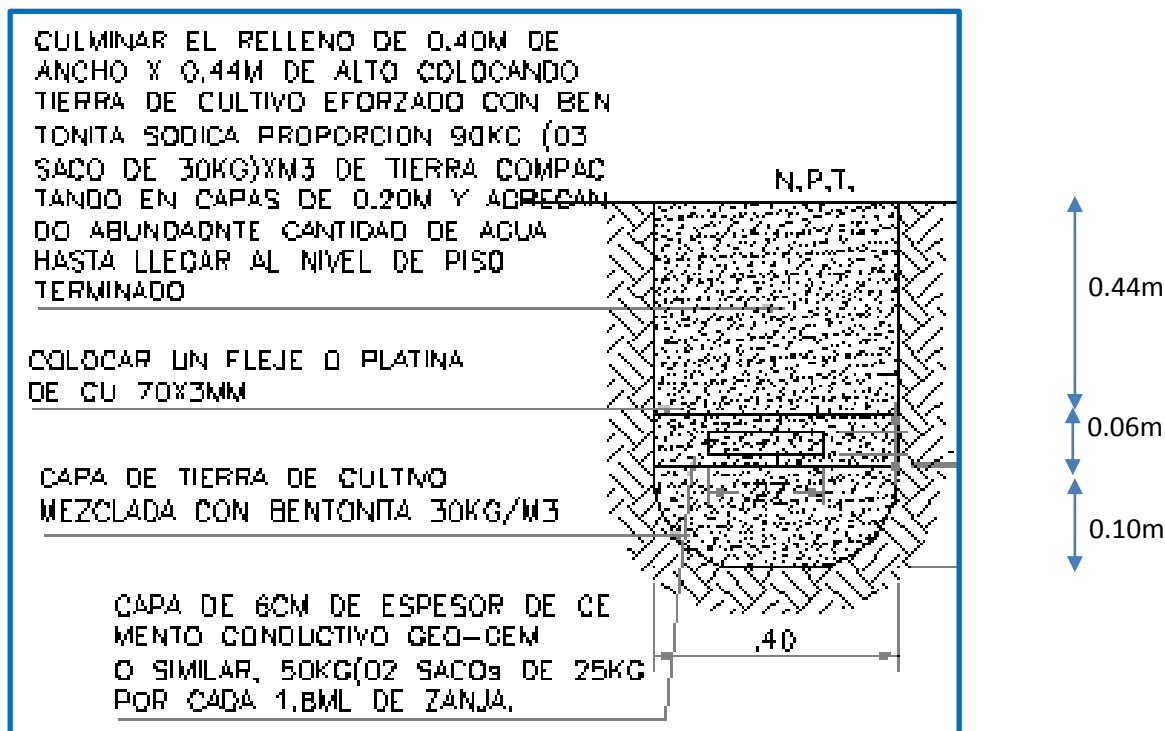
DETALLE DEL ENTERRAMIENTO DE CABLE DESNUDO EN ZANJA
